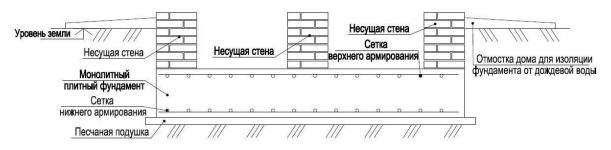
Упрощенная схема монолитного плитного фундамента [7]
